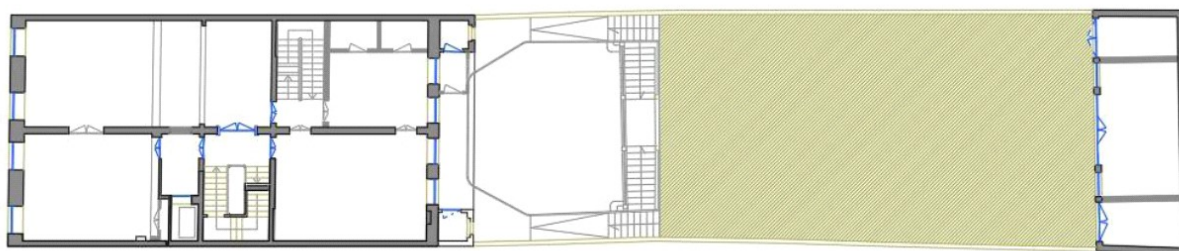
Planta de arquitetura original do piso 1 (sem escala)
